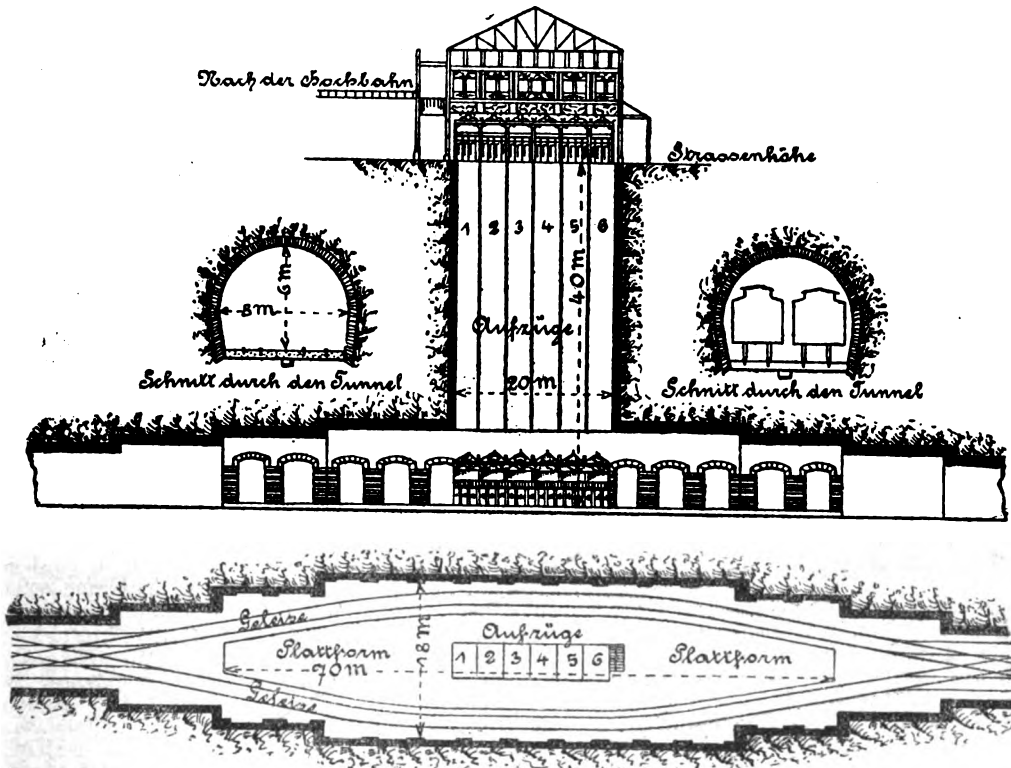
u. 181. Schnitt und Grundriss der Bahnhofsanlage in Whitehall.
